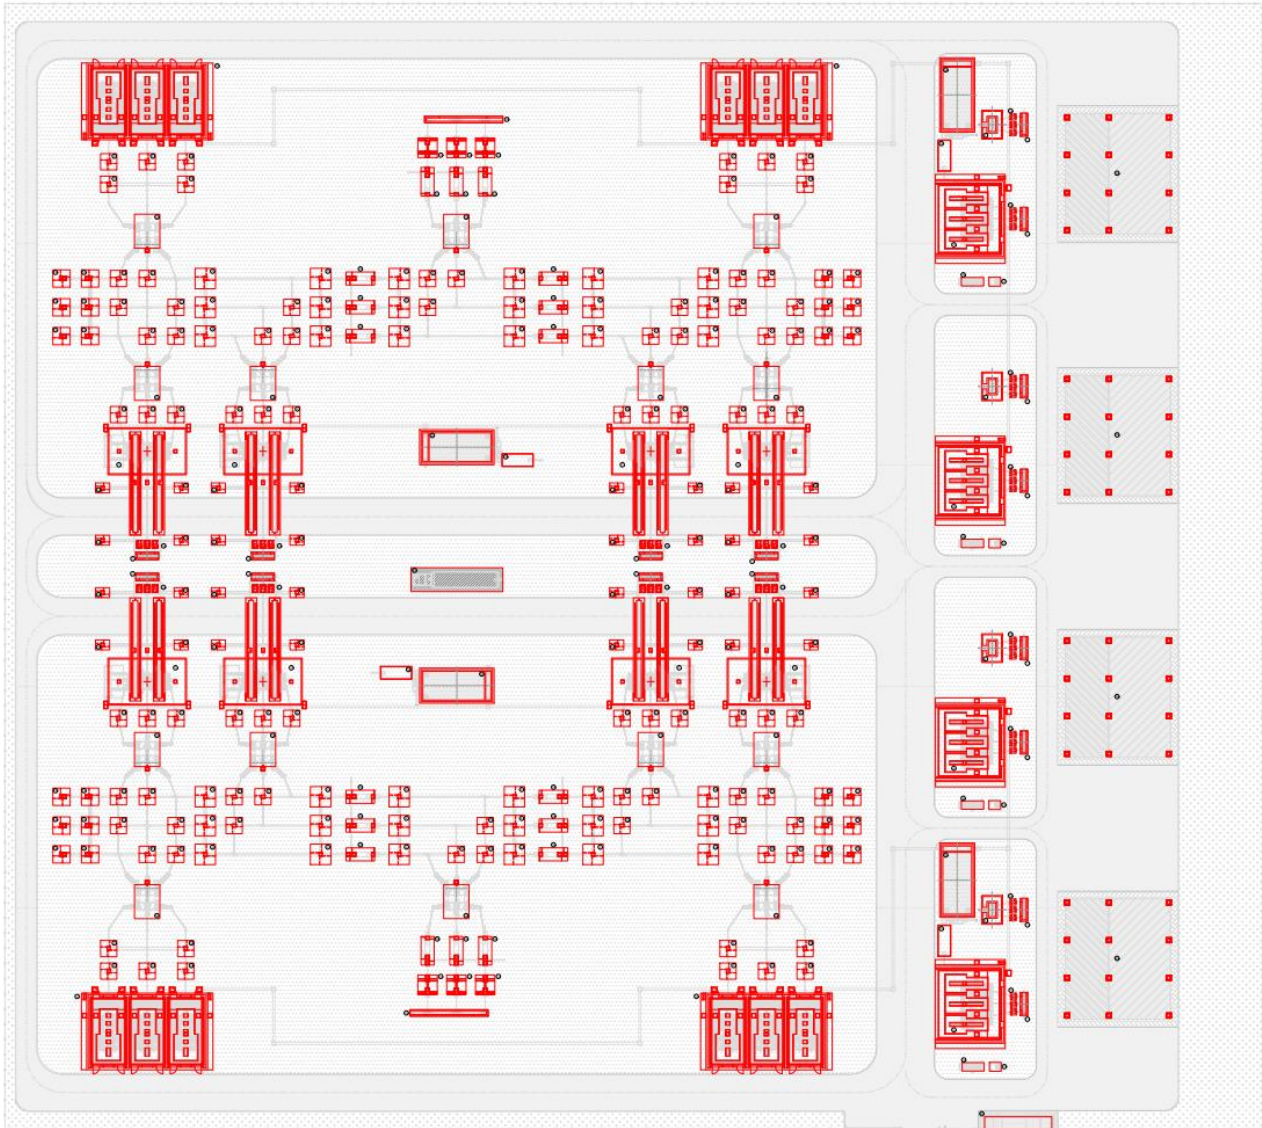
Planimetria fondazioni. [Fonte: Opere Elettriche di Connessione Parco Eolico offshore KAILIA – SE 66/380 kV. Piano Tecnico delle Opere (PTO), CEBAT S.p.A. – GEOTECH S.r. .I.]
